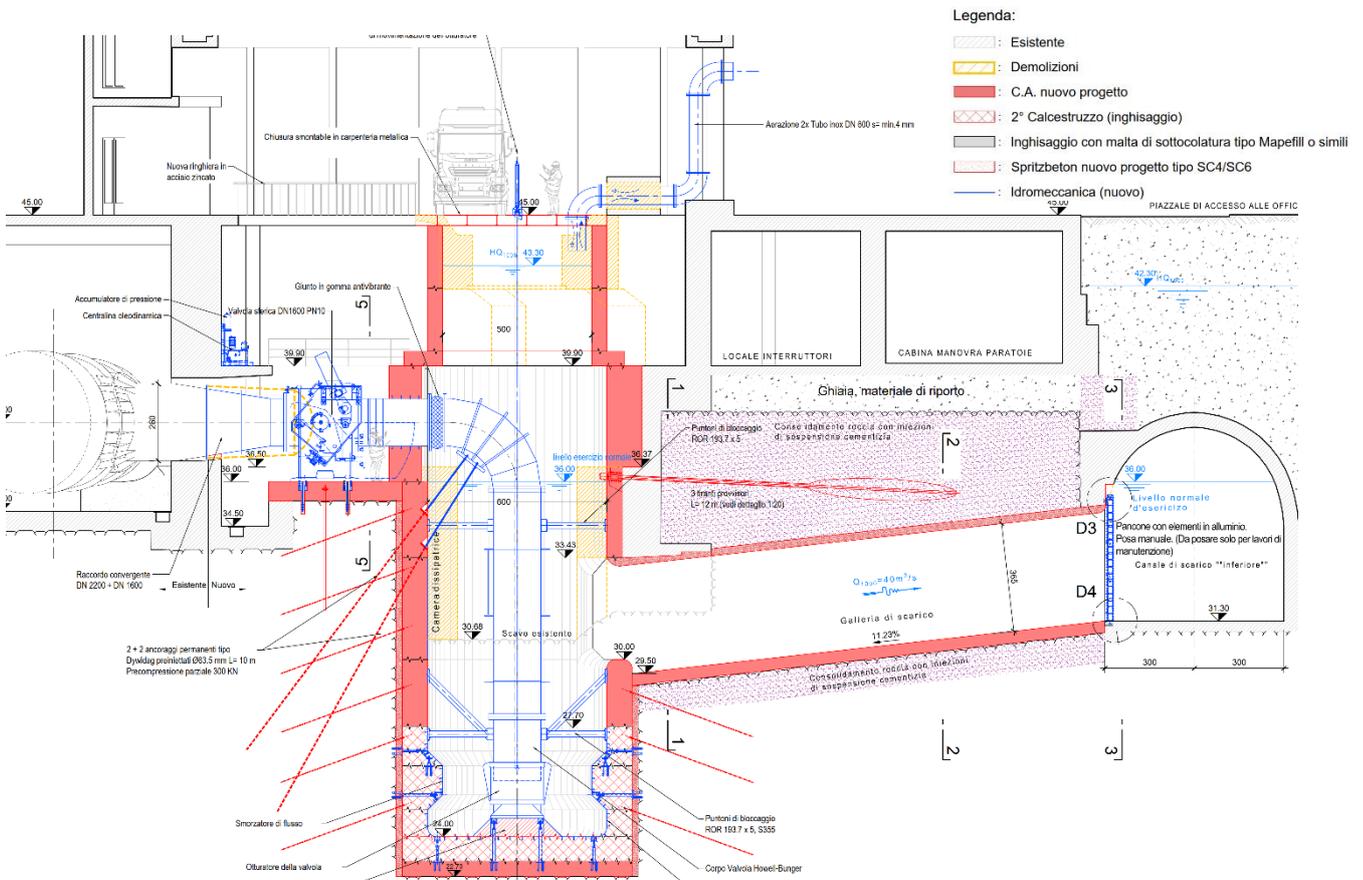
Disposizione del sistema di dissipazione - sezione sull'asse macchina e galleria raccordo
